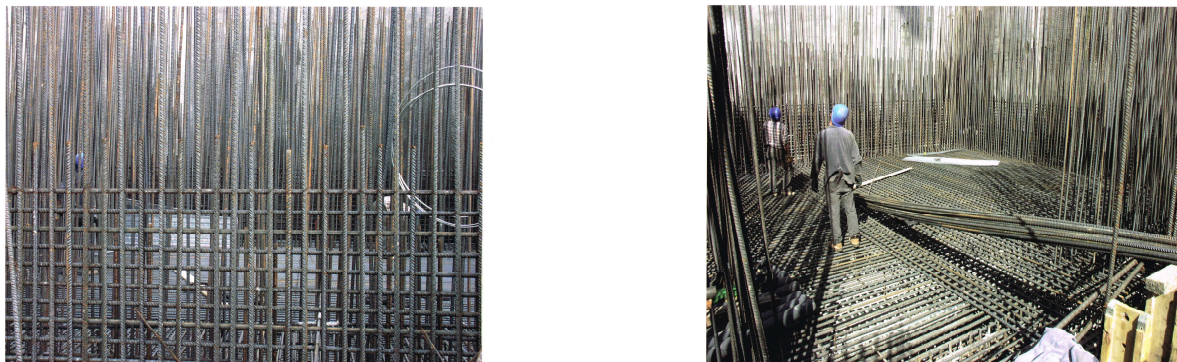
Execução de armaduras – sala do ciclotrão
